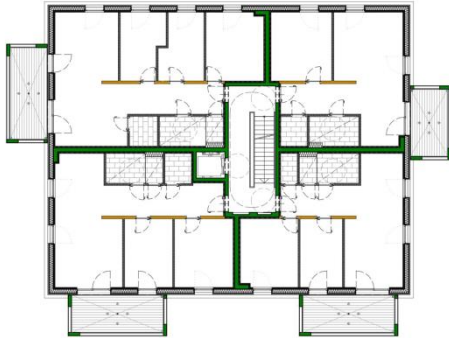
Grundriss 3. OG als 7-Geschosser Forschungsprojekt Haus A
